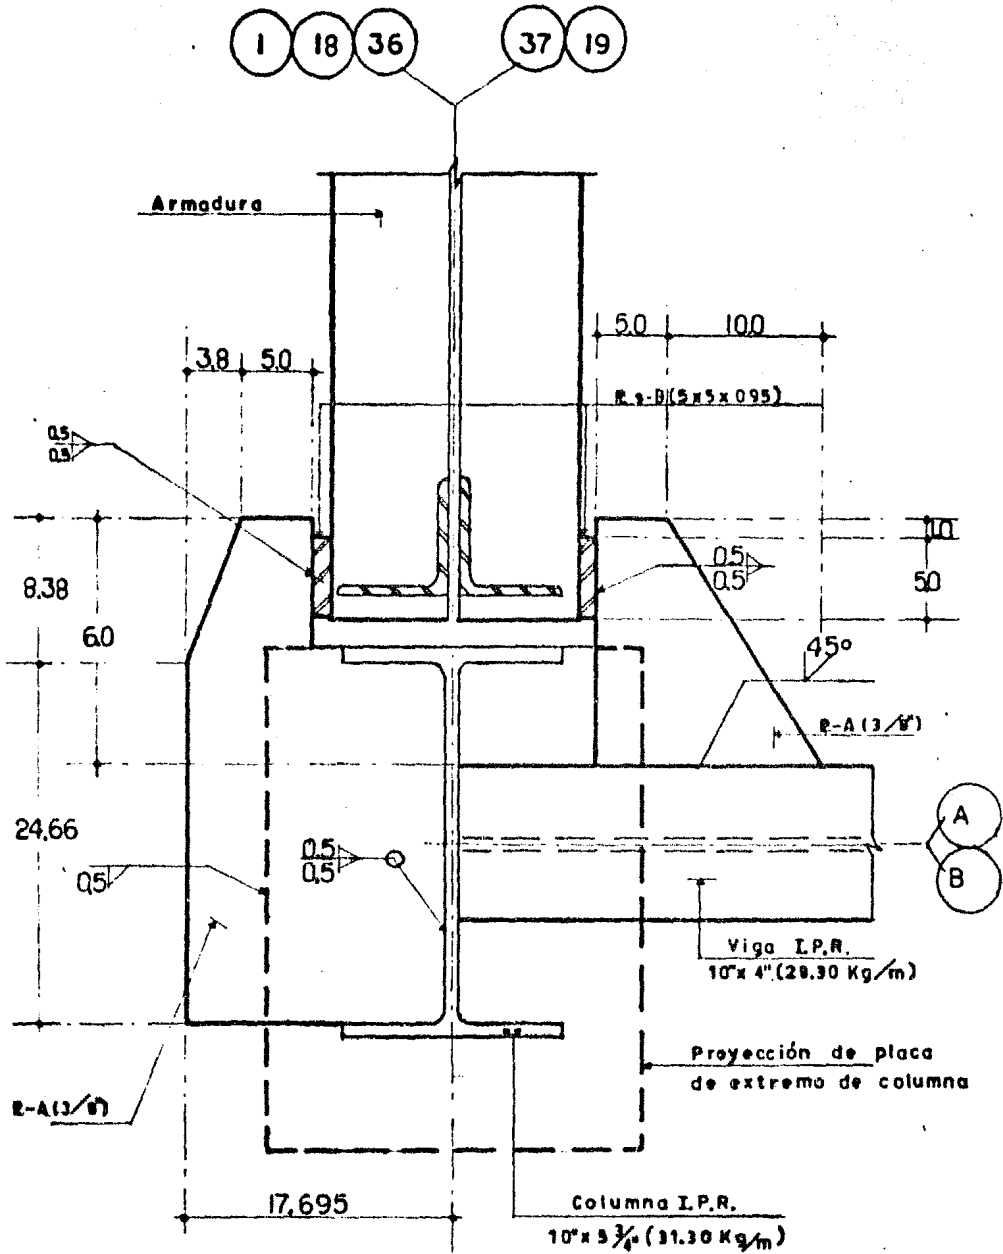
Soporte lateral de armaduras en juntas constructivas.
